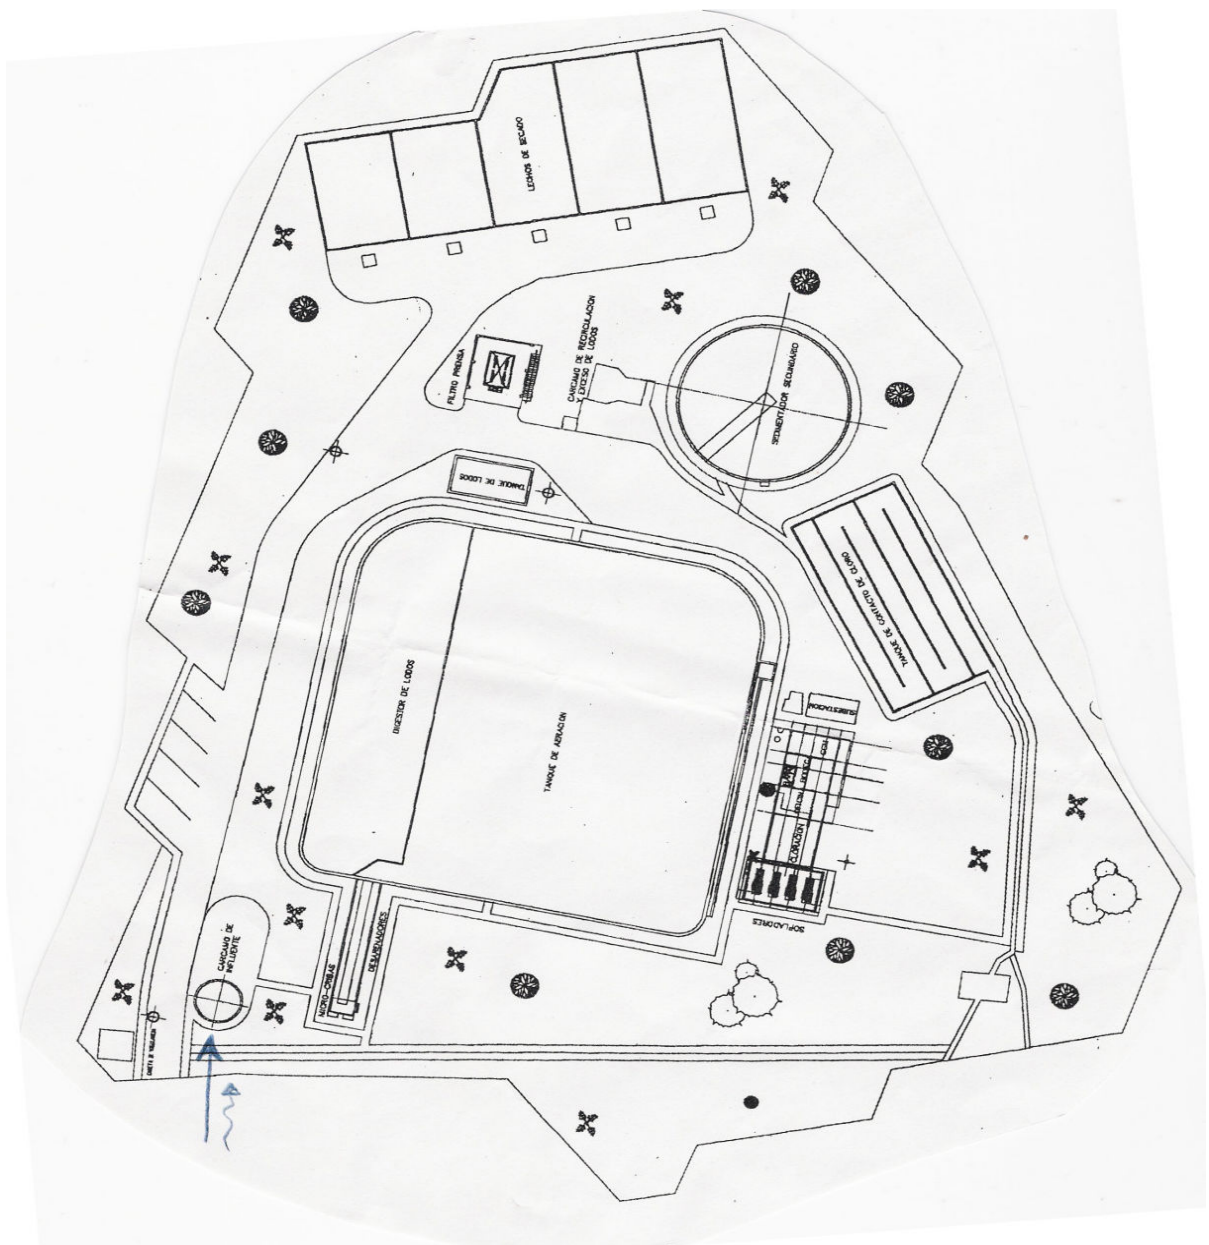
10 Planta de tratamiento al final de un sistema de alcantarillado.
